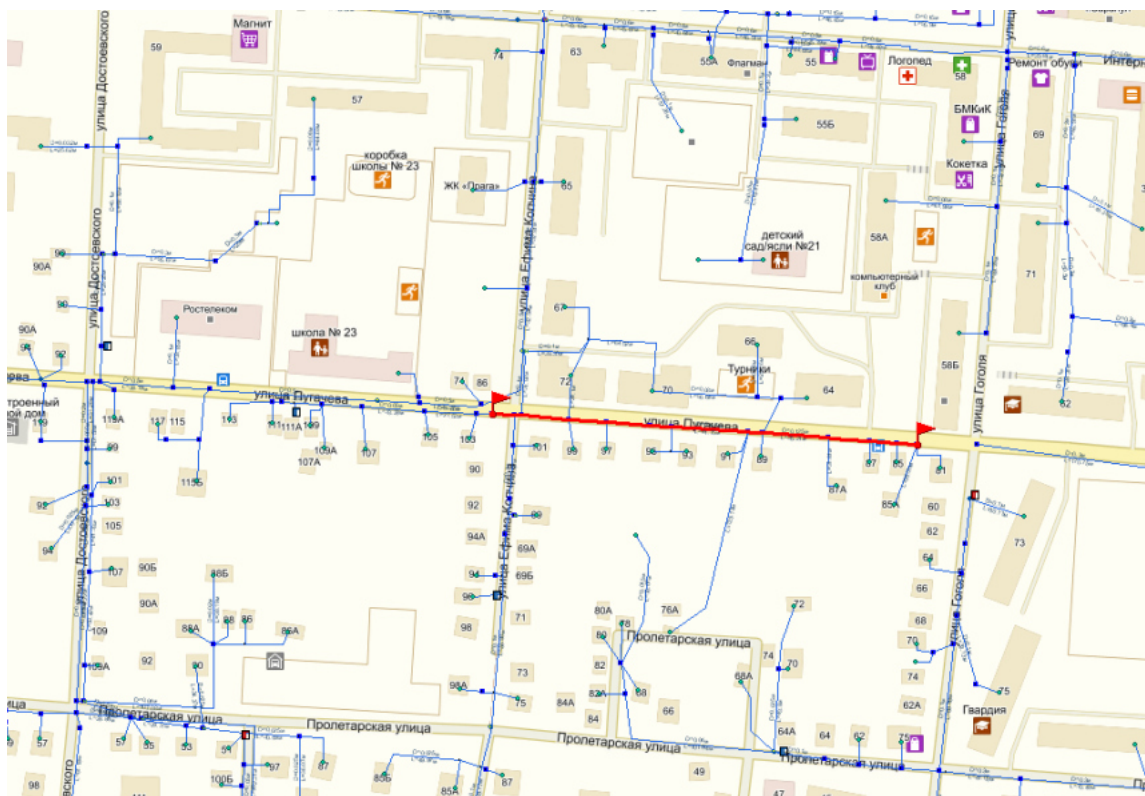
Участок водопроводной сети от ВК-3-78-49-1 до ВК-3-78-48-11
